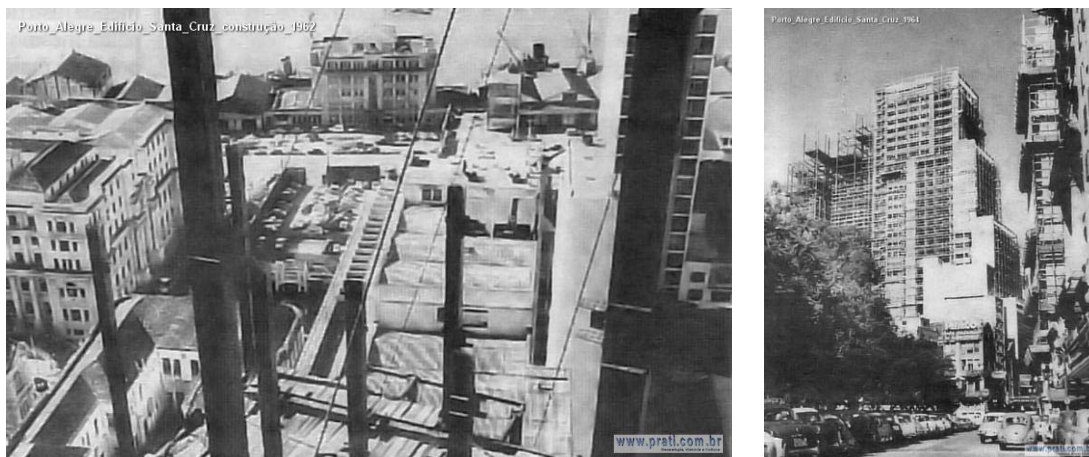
Edifício Santa Cruz durante a montagem da estrutura metálica em 1962 e no término de sua obra em 1964²⁴
